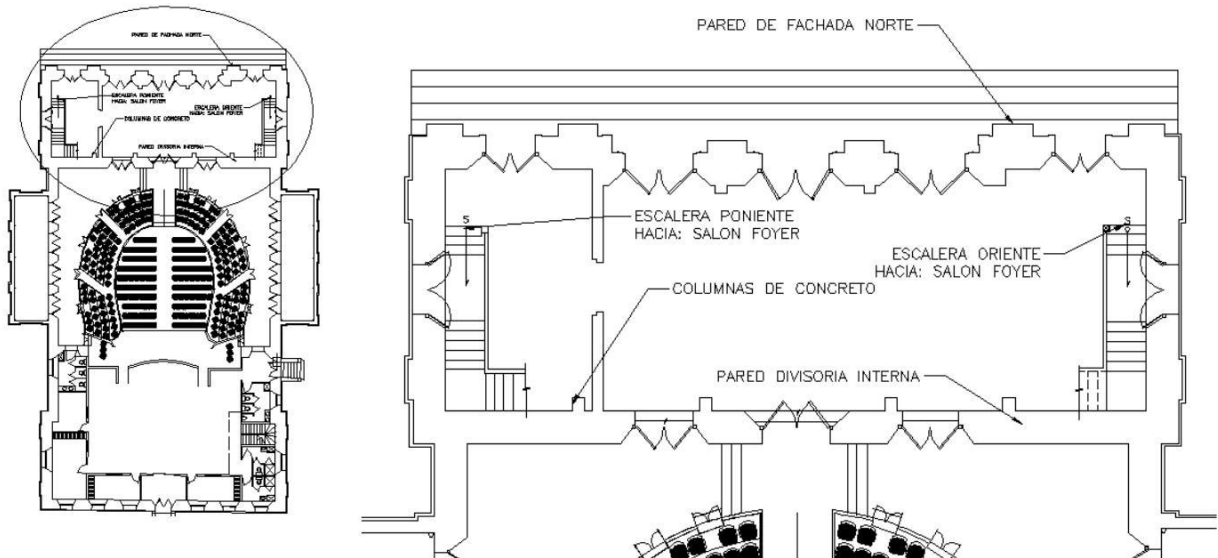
A la izquierda, vista en planta del Teatro de San Miguel, con la zona a intervenir marcada. A la derecha, vista en planta del vestíbulo o Lobby (primer nivel). Sobre el Lobby se encuentra el Salón Foyer.
